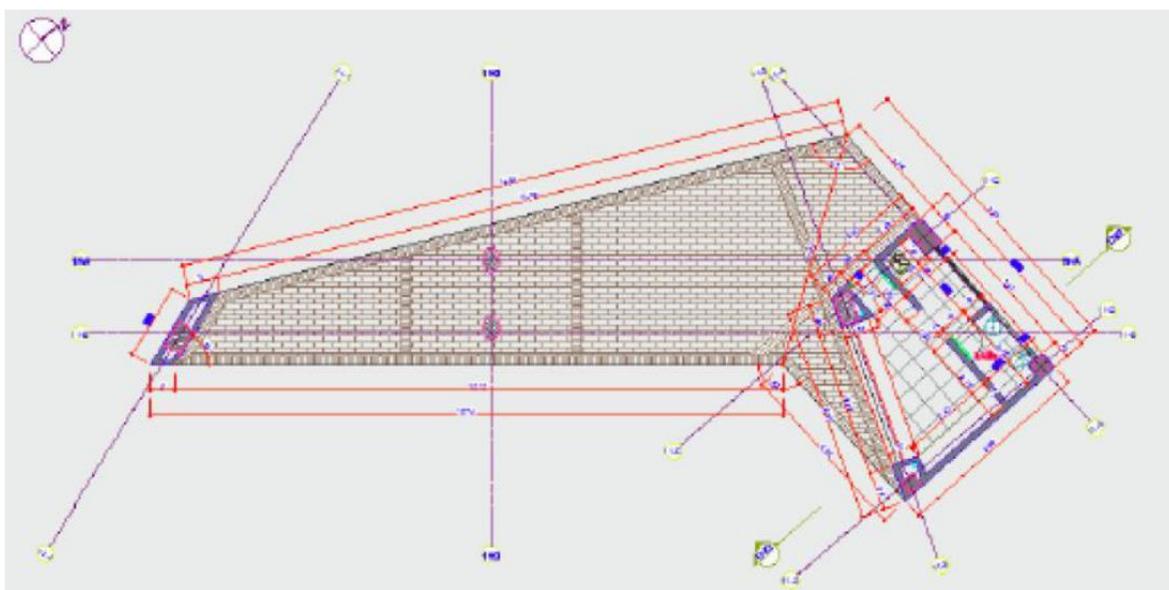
Vista en planta Portería. Unión temporal SENA (2019).
